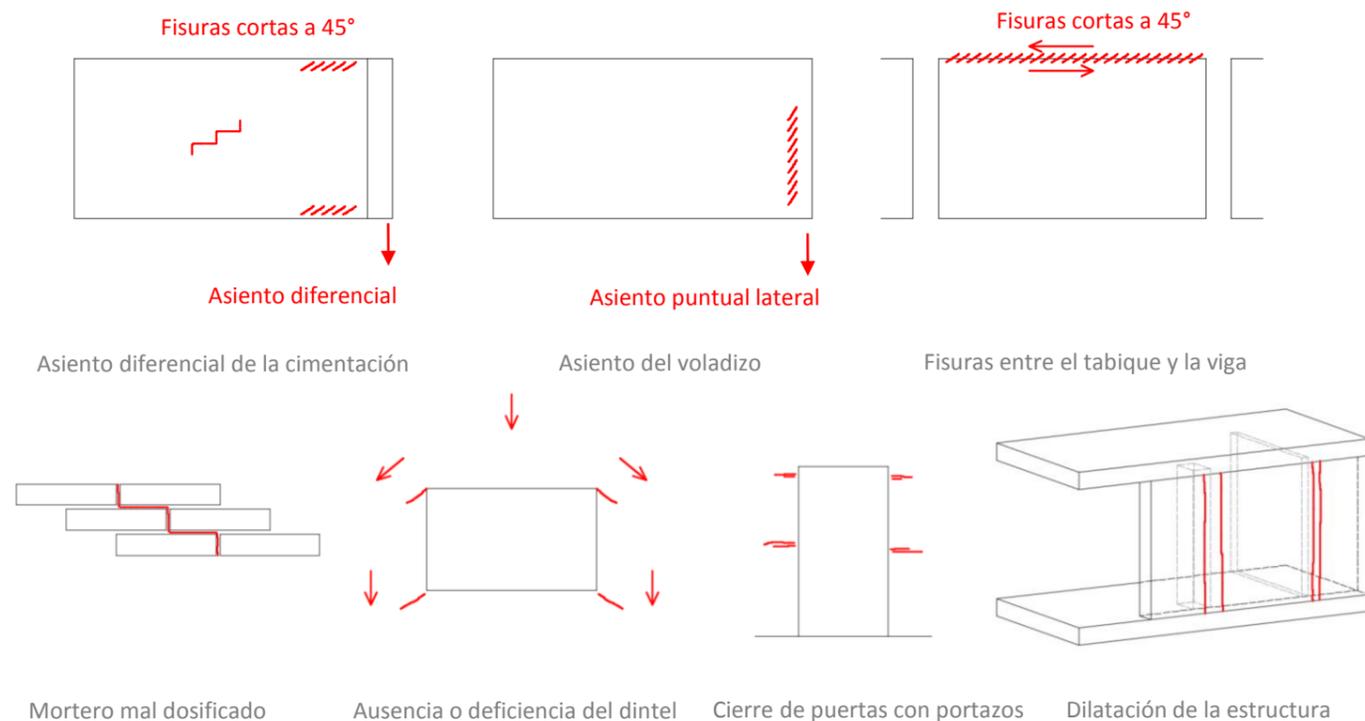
Tipos y causas de fisuras. 2018. Elaboración propia
